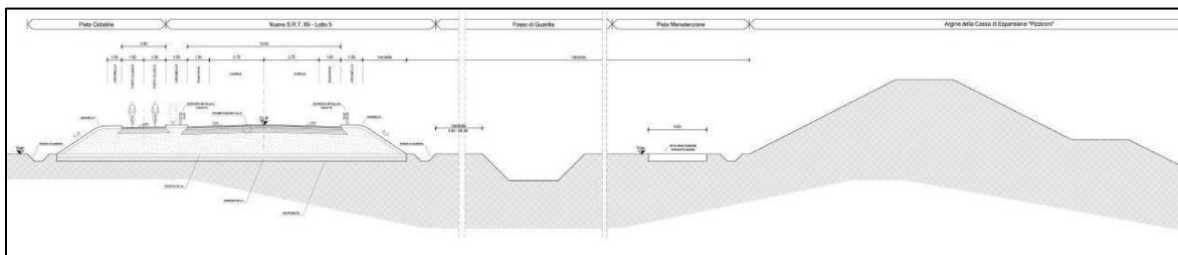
Sezione tipo 1: strada, fosso di guardia e argine della cassa d'espansione
